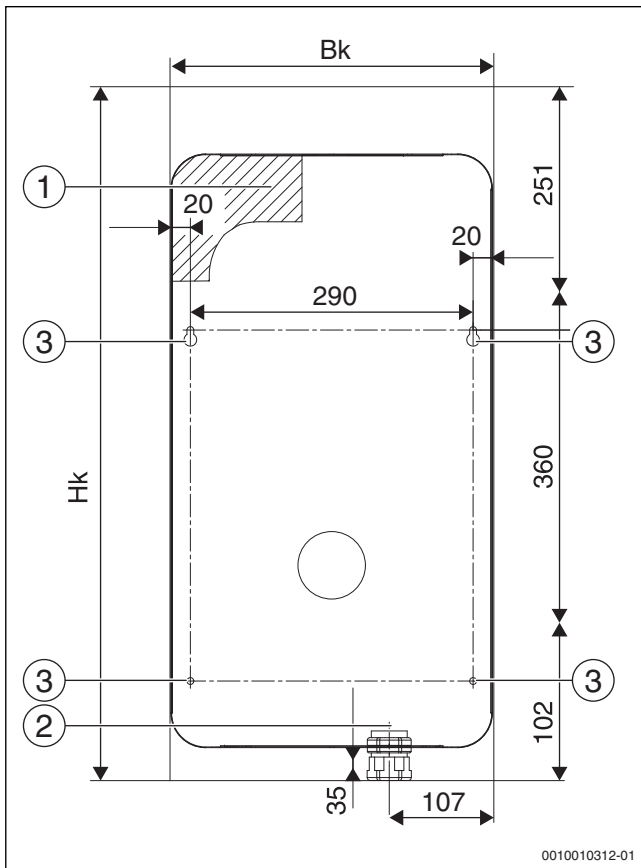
Abmessungen der Bohrungen für das Befestigen des Heizkessels an der Wand und für das Versorgungskabel beim Heizkessel Tronic Heat 3000 4-12 kW
